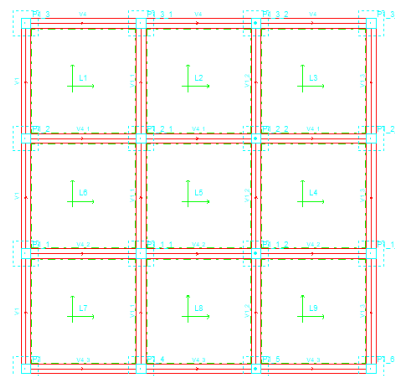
Planta baixa dos pavimentos tipo dos edifícios
